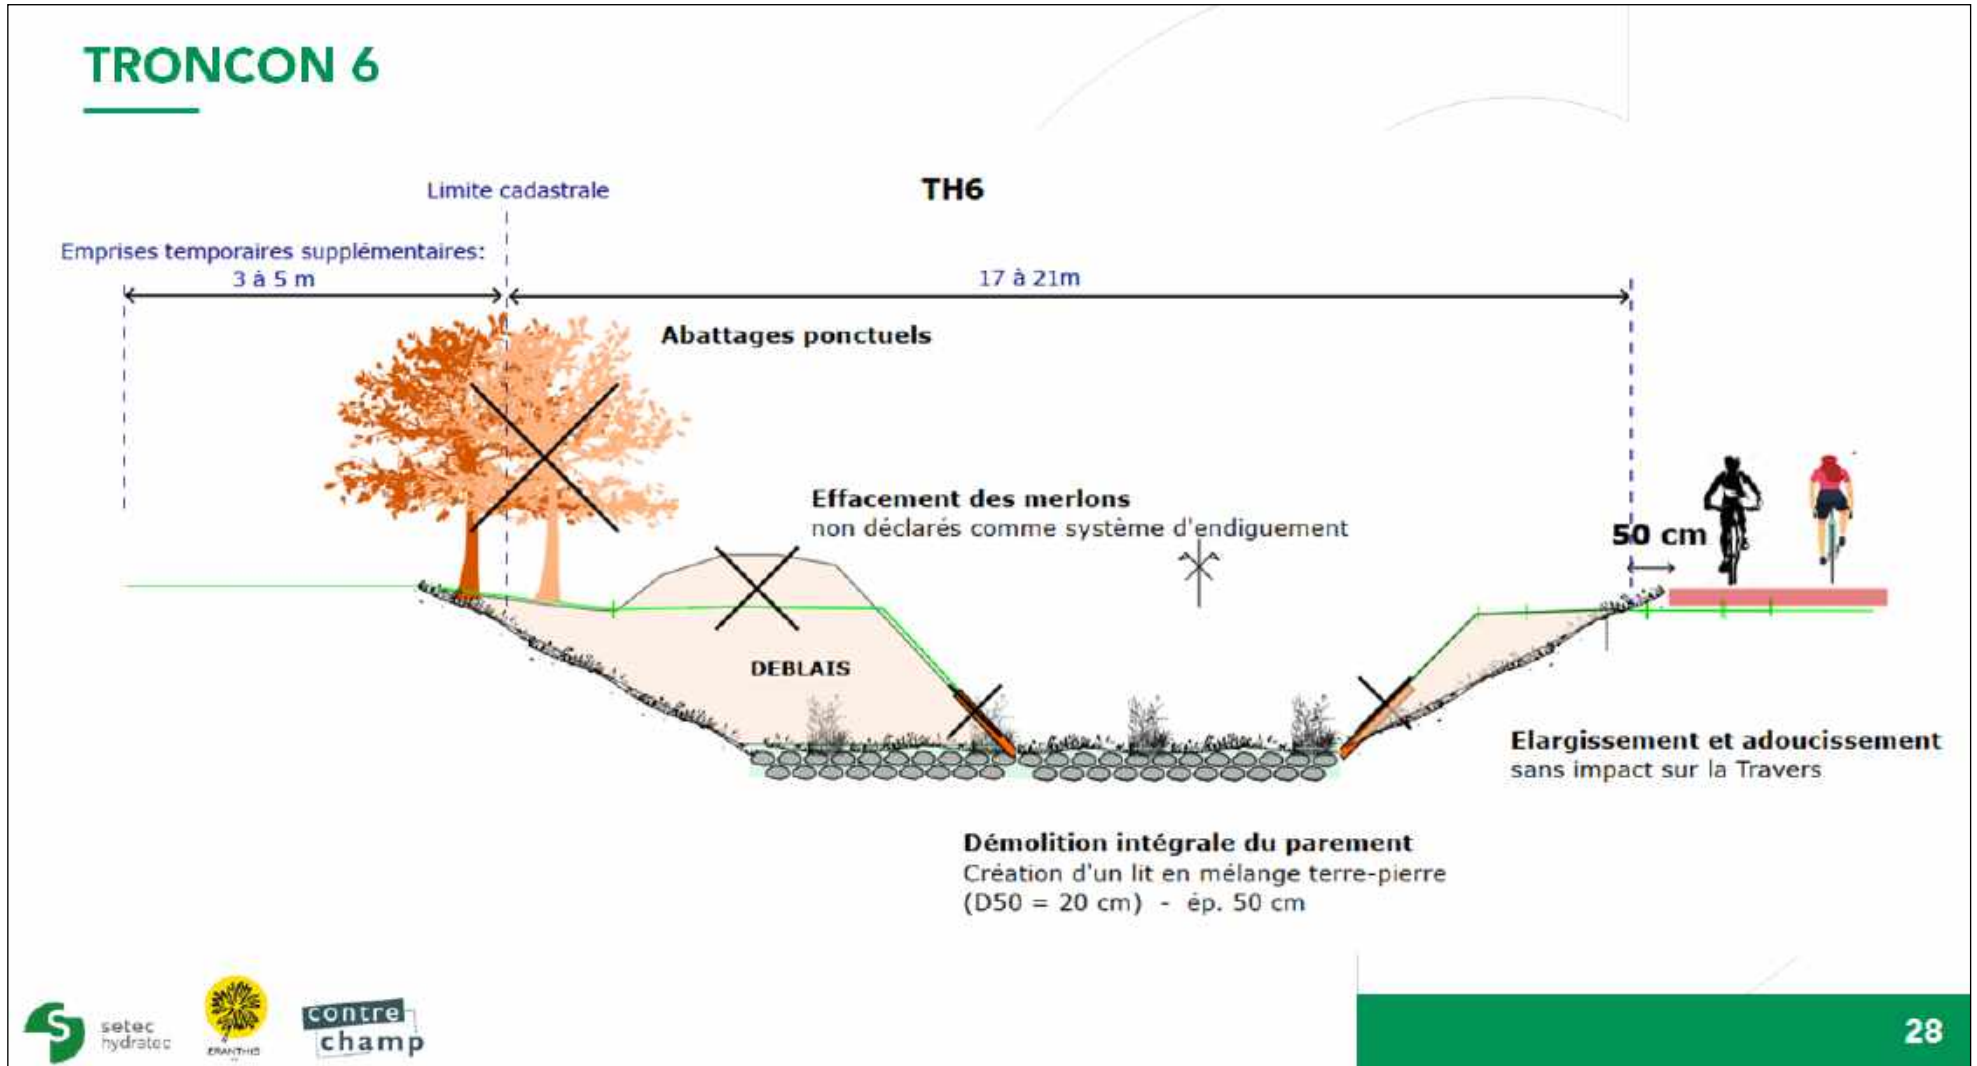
Profil en travers sur le tronçons 6 (SETEC/HYDRATEC)
